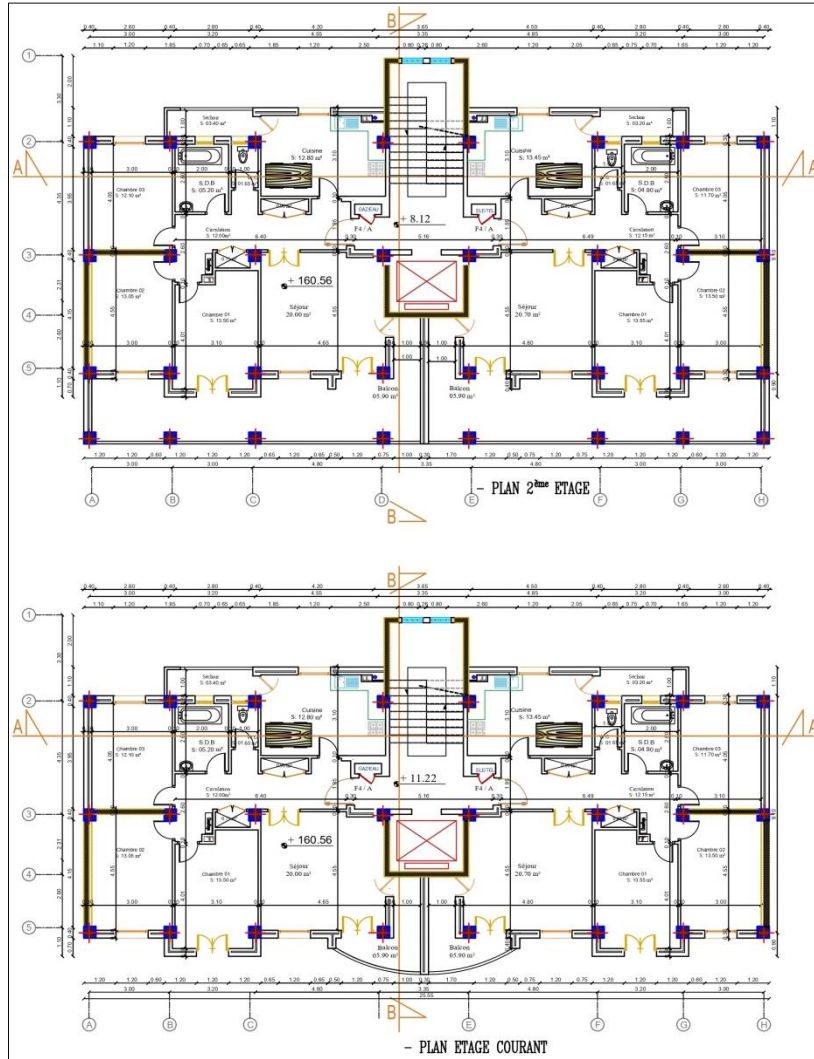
Vues en plan (plan 2ème étage et plan étage courant)
